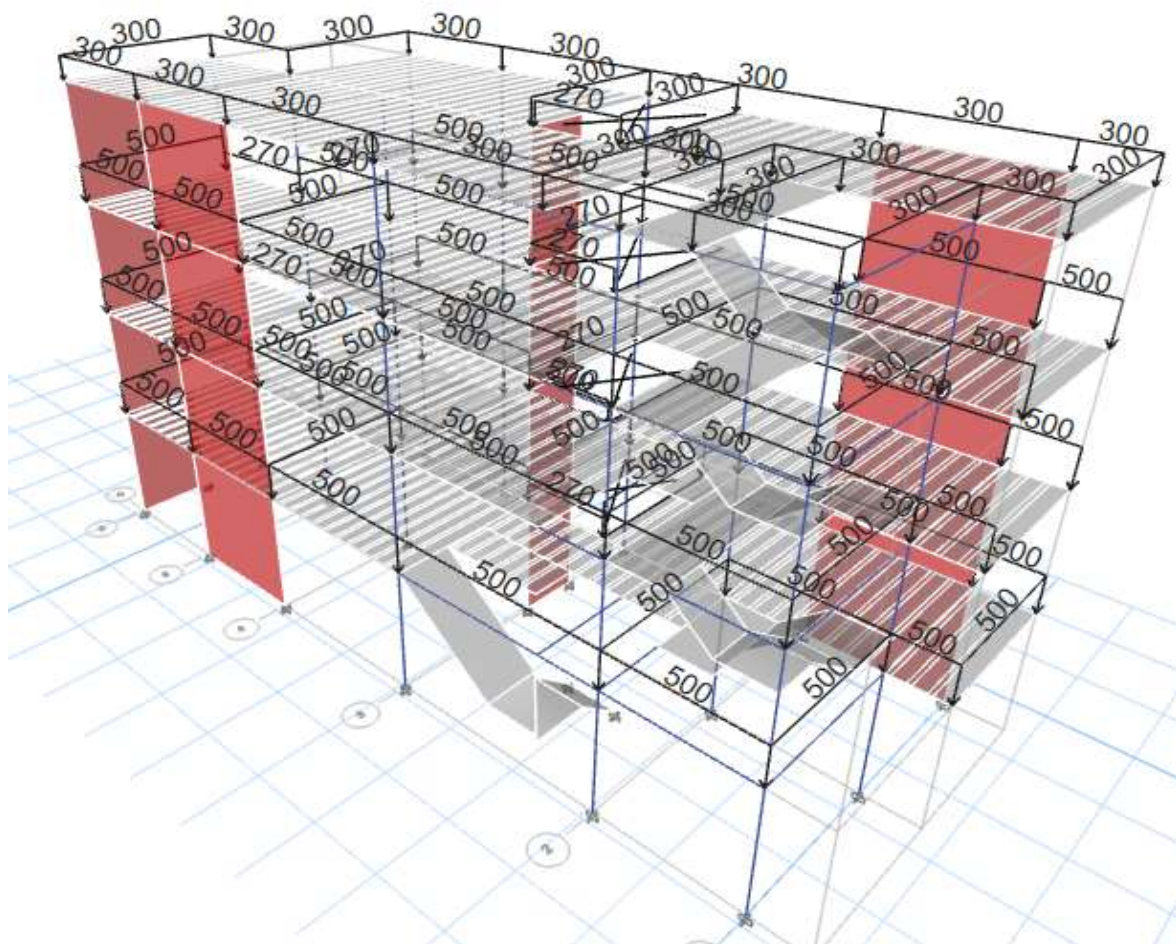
Vista 3d Asignación de Carga Muerta sobre las Vigas Perimetrales de la Edificación
